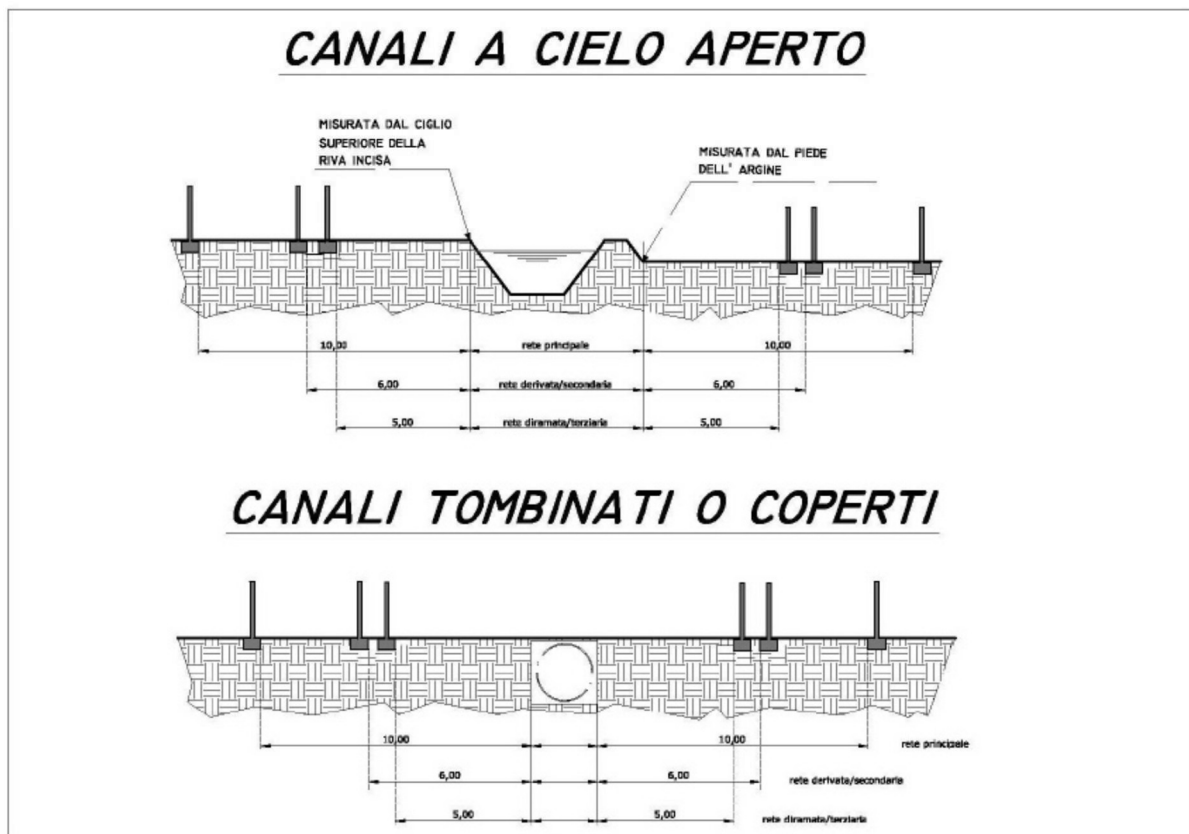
Estratto Allegato C per il calcolo delle fasce di rispetto dei canali.
